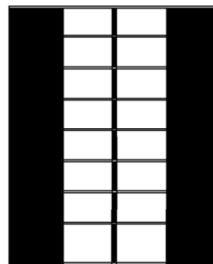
Disposició en planta i alçat de les pantalles segons la distribució tipus B
